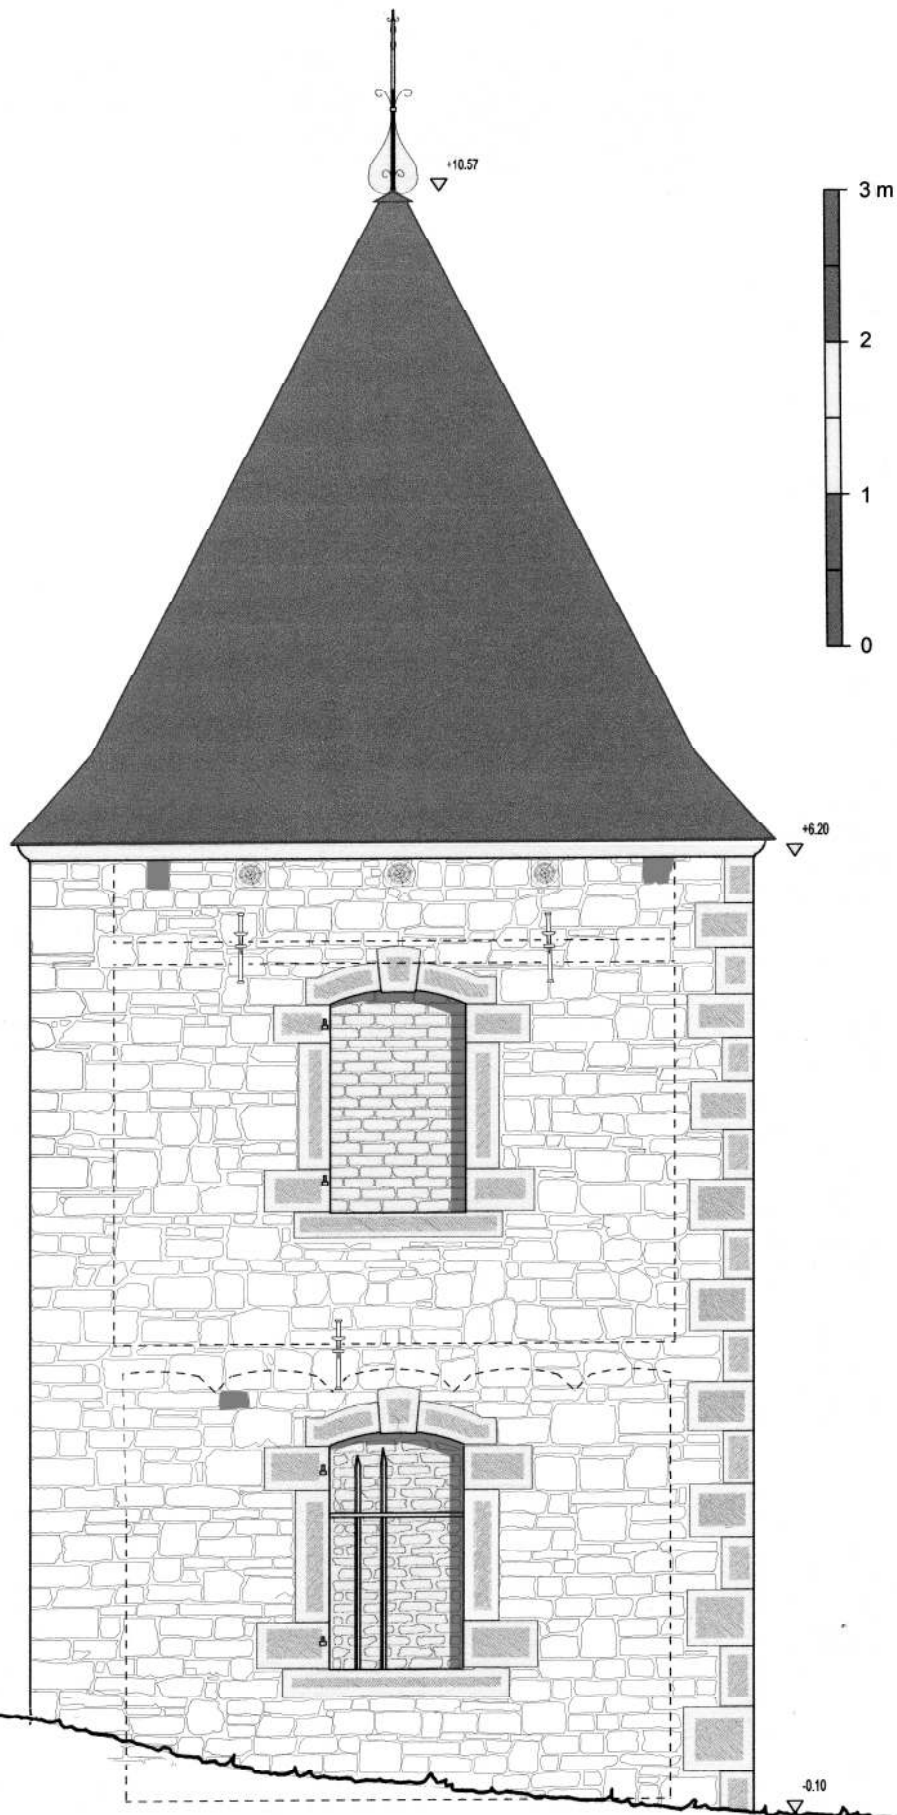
Pavillon. Elévation NE. Ech. 1/50°. IG 2003.
